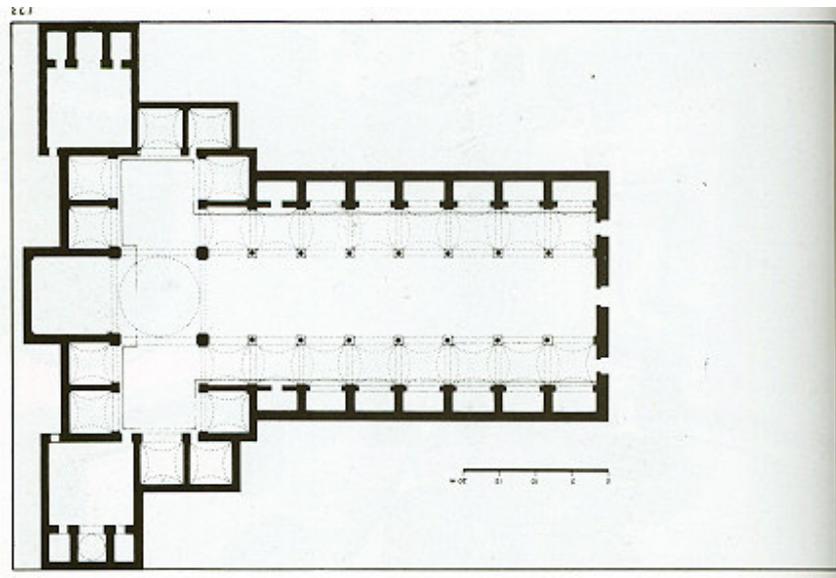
Planta da Igreja de S. Lorenzo projetada por Brunelleschi
